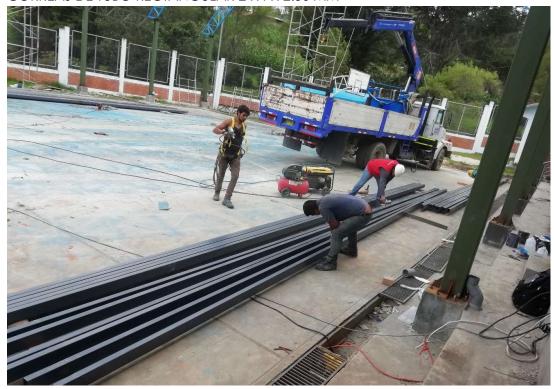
IZAMIENTO DE ARMADURAS METÁLICAS
